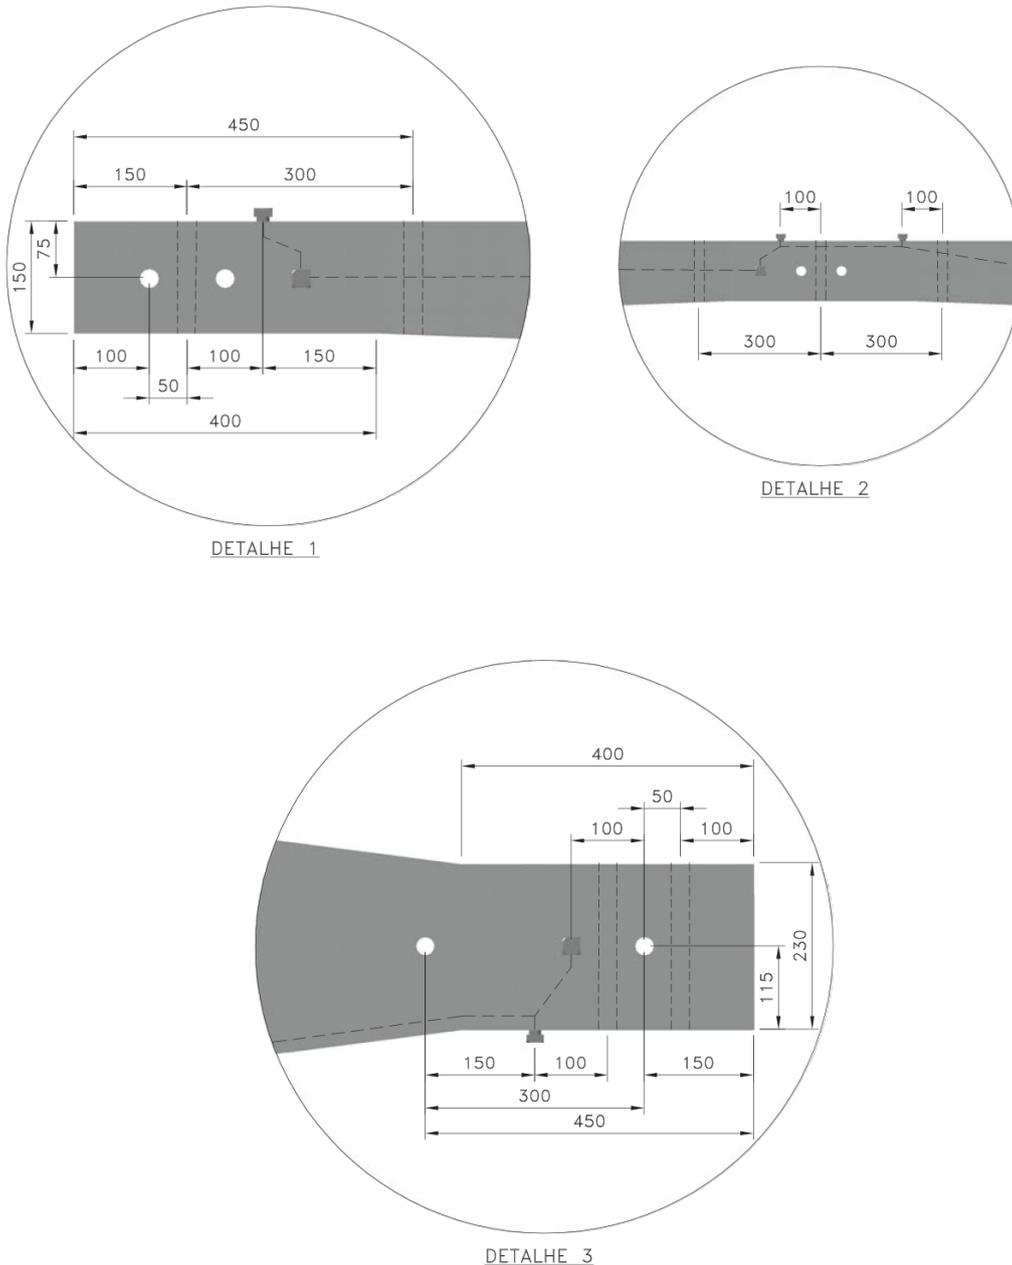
Cruzeta de concreto armado simples - tipo "H" – 6700mm - detalhes
